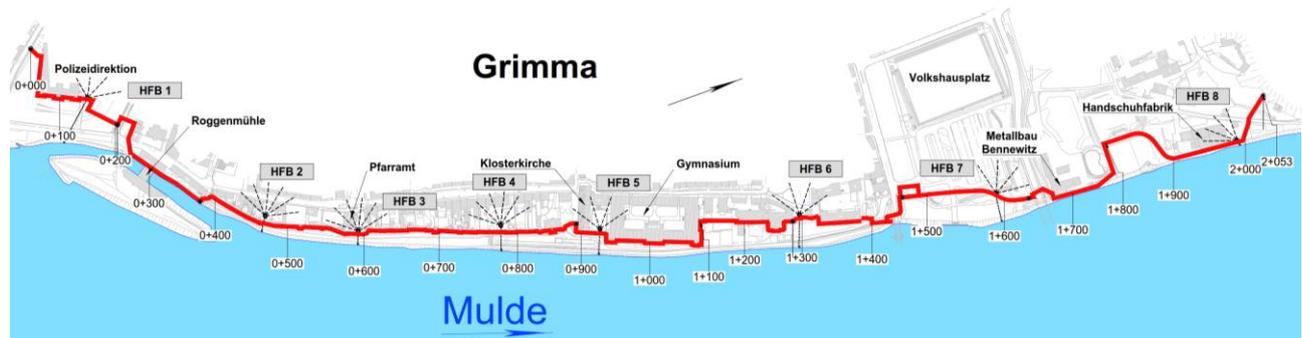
Übersichtslageplan der Schachtstandorte
